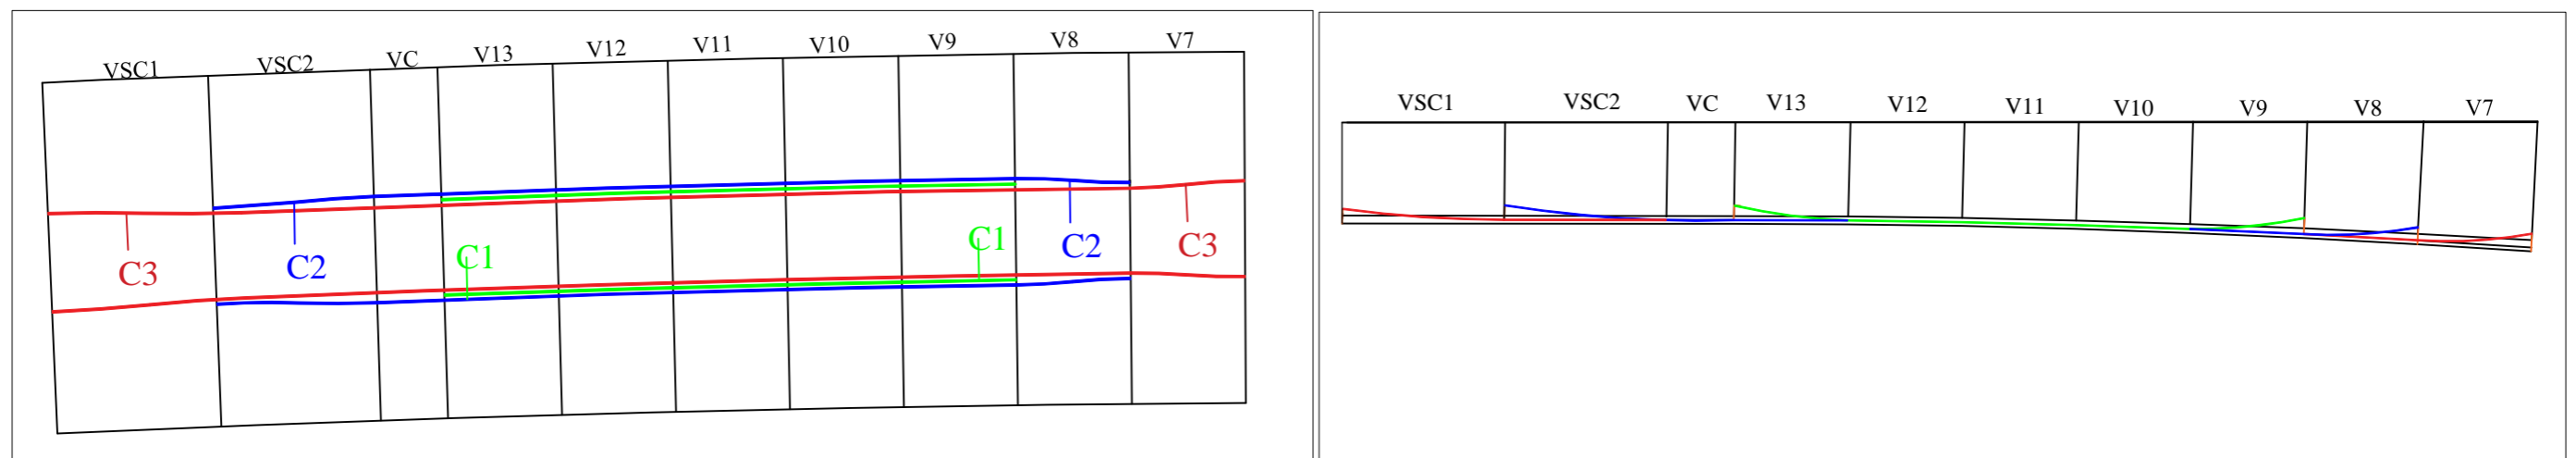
Tracé en élévation et en plan des câbles de continuité de travée de rive.
